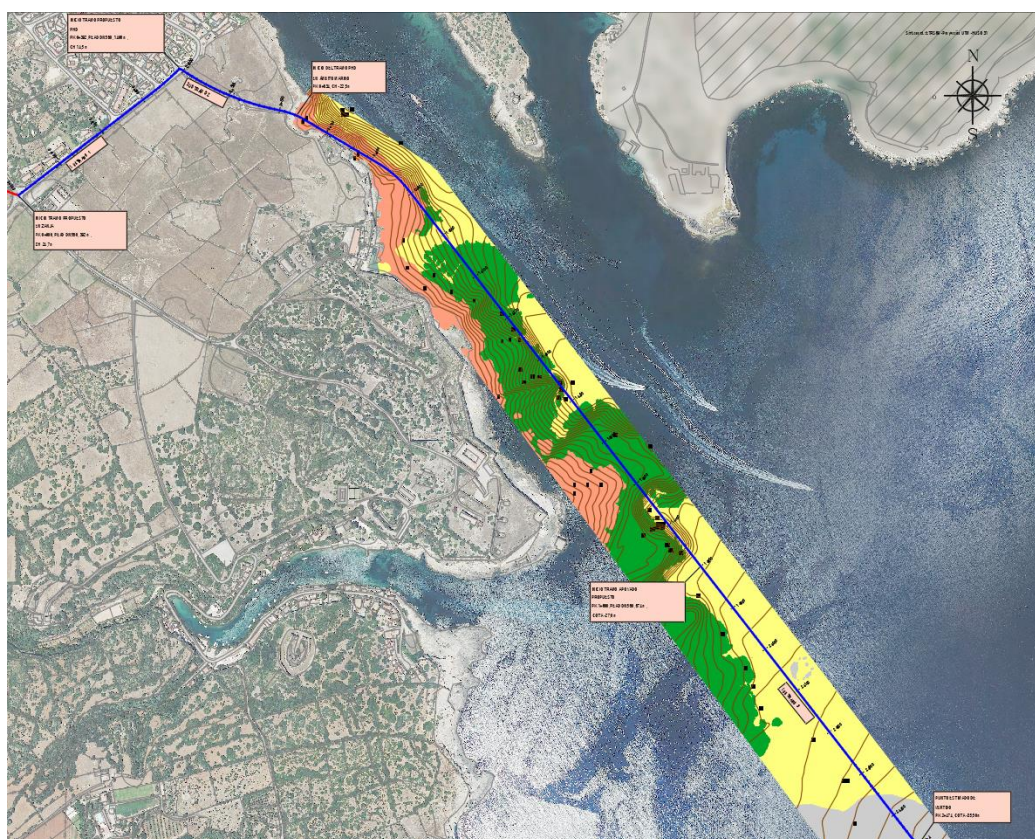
Trazado en planta propuesto para los tramos terrestre y en PHD.
